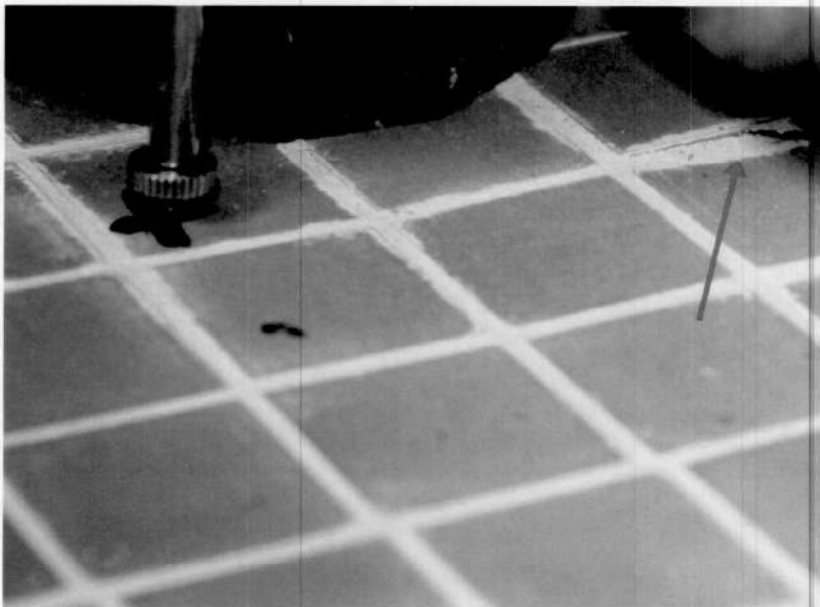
Detailansicht Belastungspunkt 1 - Riss in Verfugung
